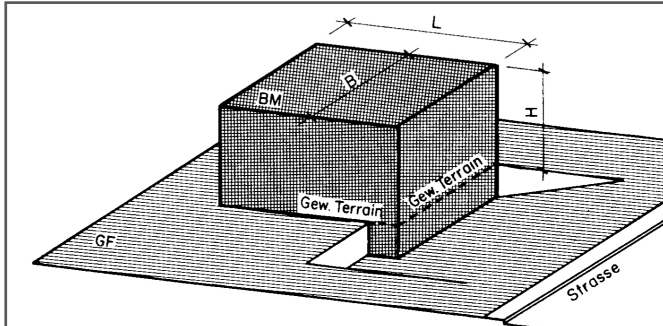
Baumassenberechnung / oberirdisches Bauvolumen. Auch Volumen unter dem gewachsenen Terrain zählen bei Abgrabungen zur Baumasse.
